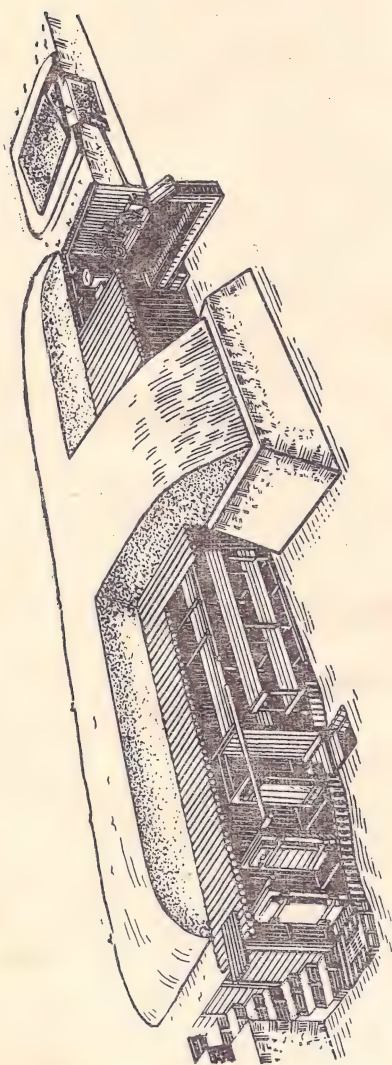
Убежище безврубочной конструкции из лесоматериала (обеспечивает защиту в зоне давлений до 2 кг/см^2)
